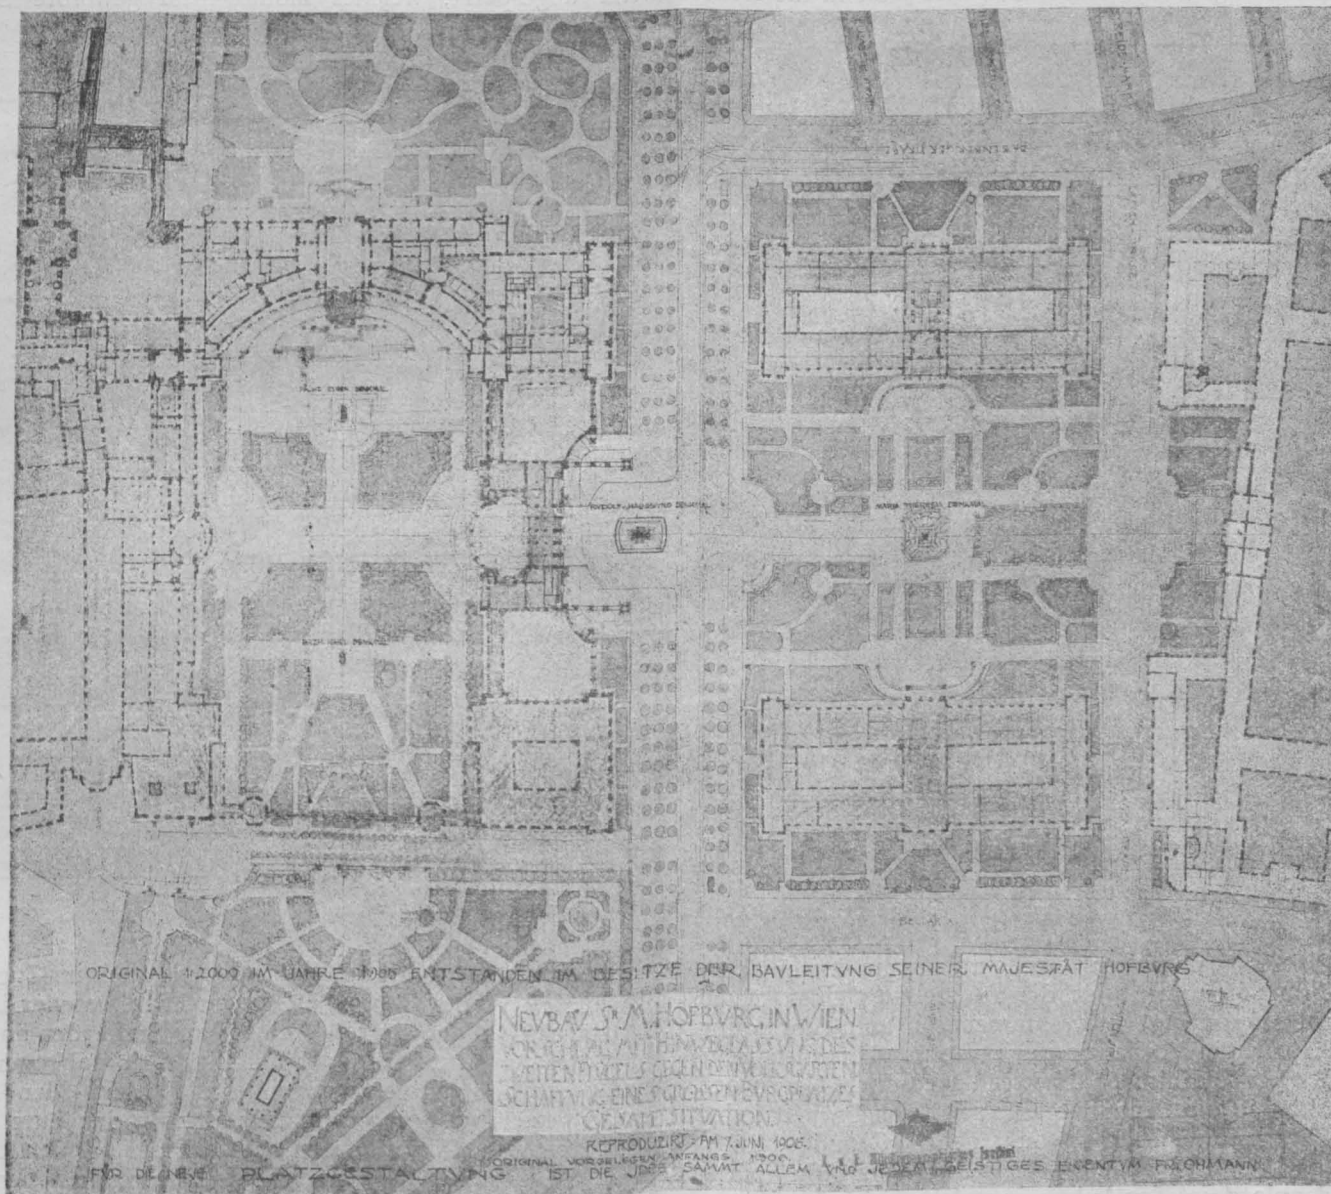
Burgbauentwurf Ohmann: Grundriß der Gesamtanlage.
